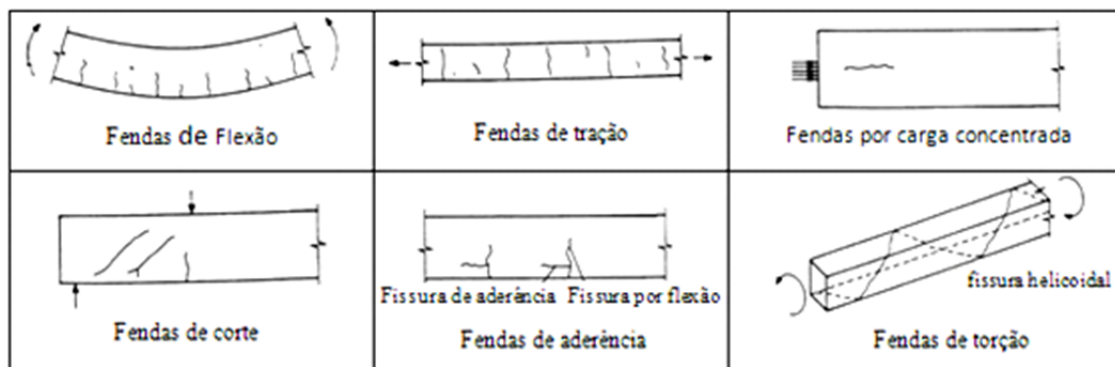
Principais fissuras devido às cargas aplicadas (Coutinho, 2005).
